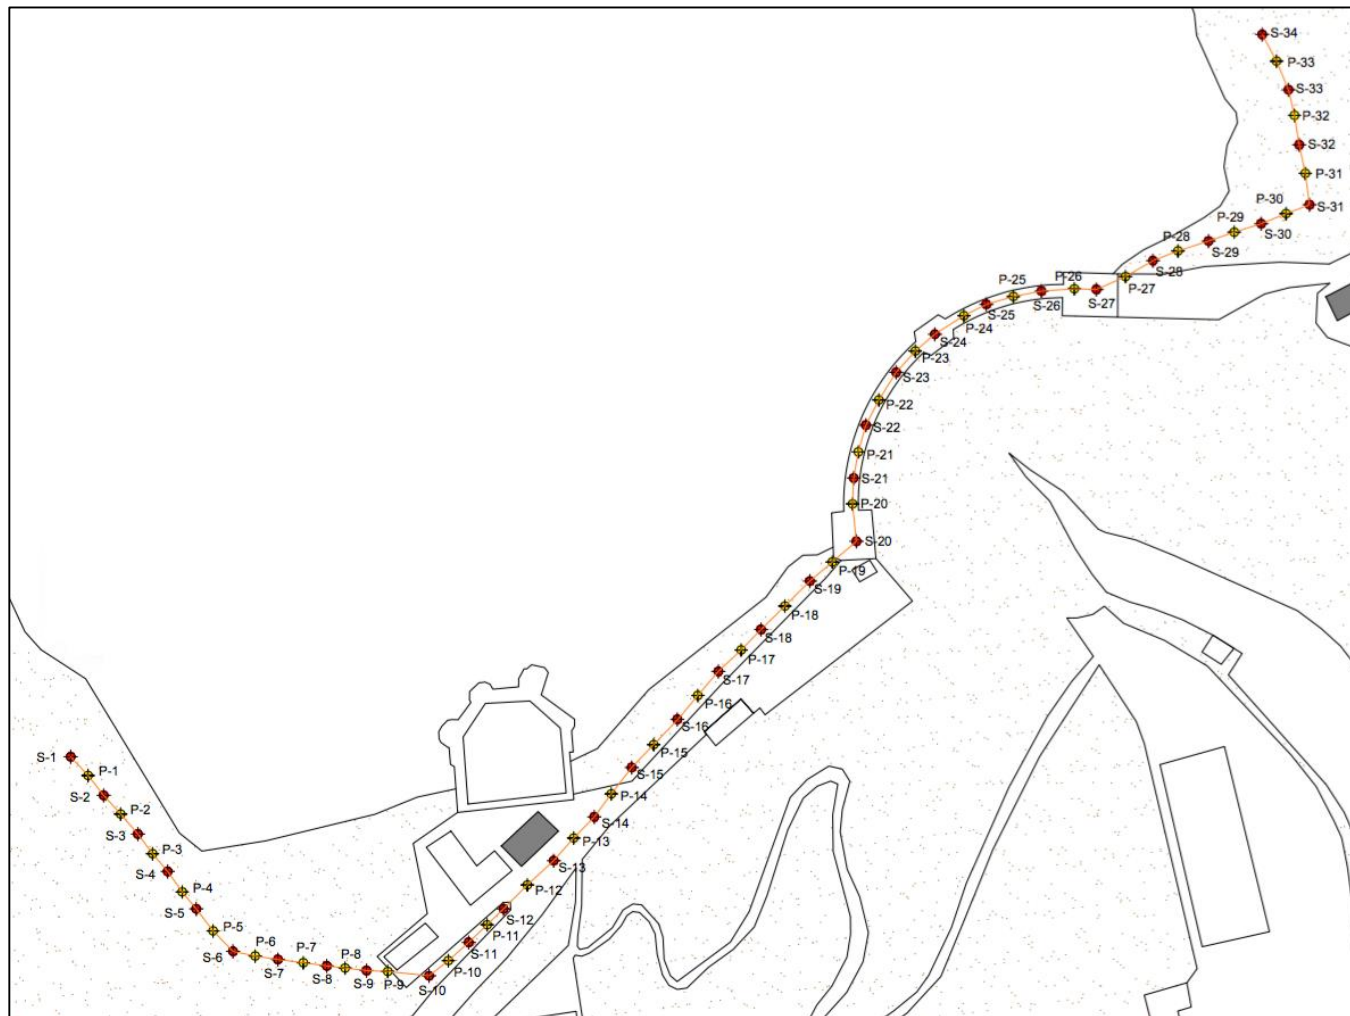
Disposición en planta de los taladros. Fuente: Propia
